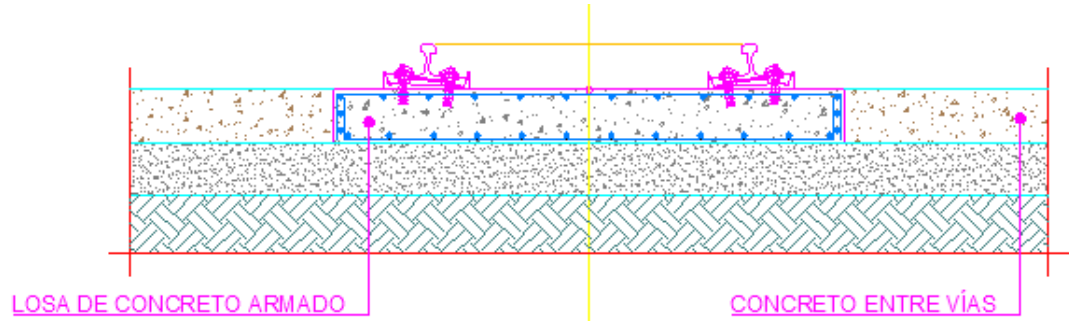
Vía férrea instalada sobre losa de concreto. Fuente: Elaboración propia
